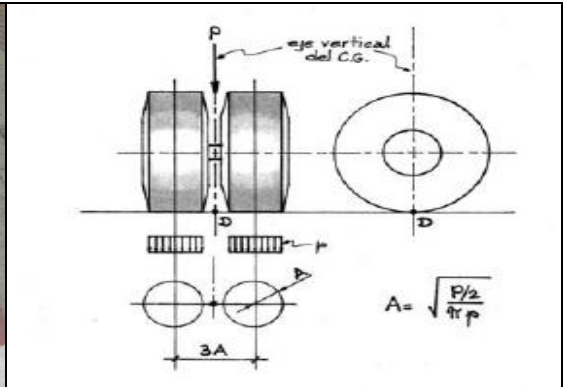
Centro de gravedad y correcta posición la Viga Benkelman
